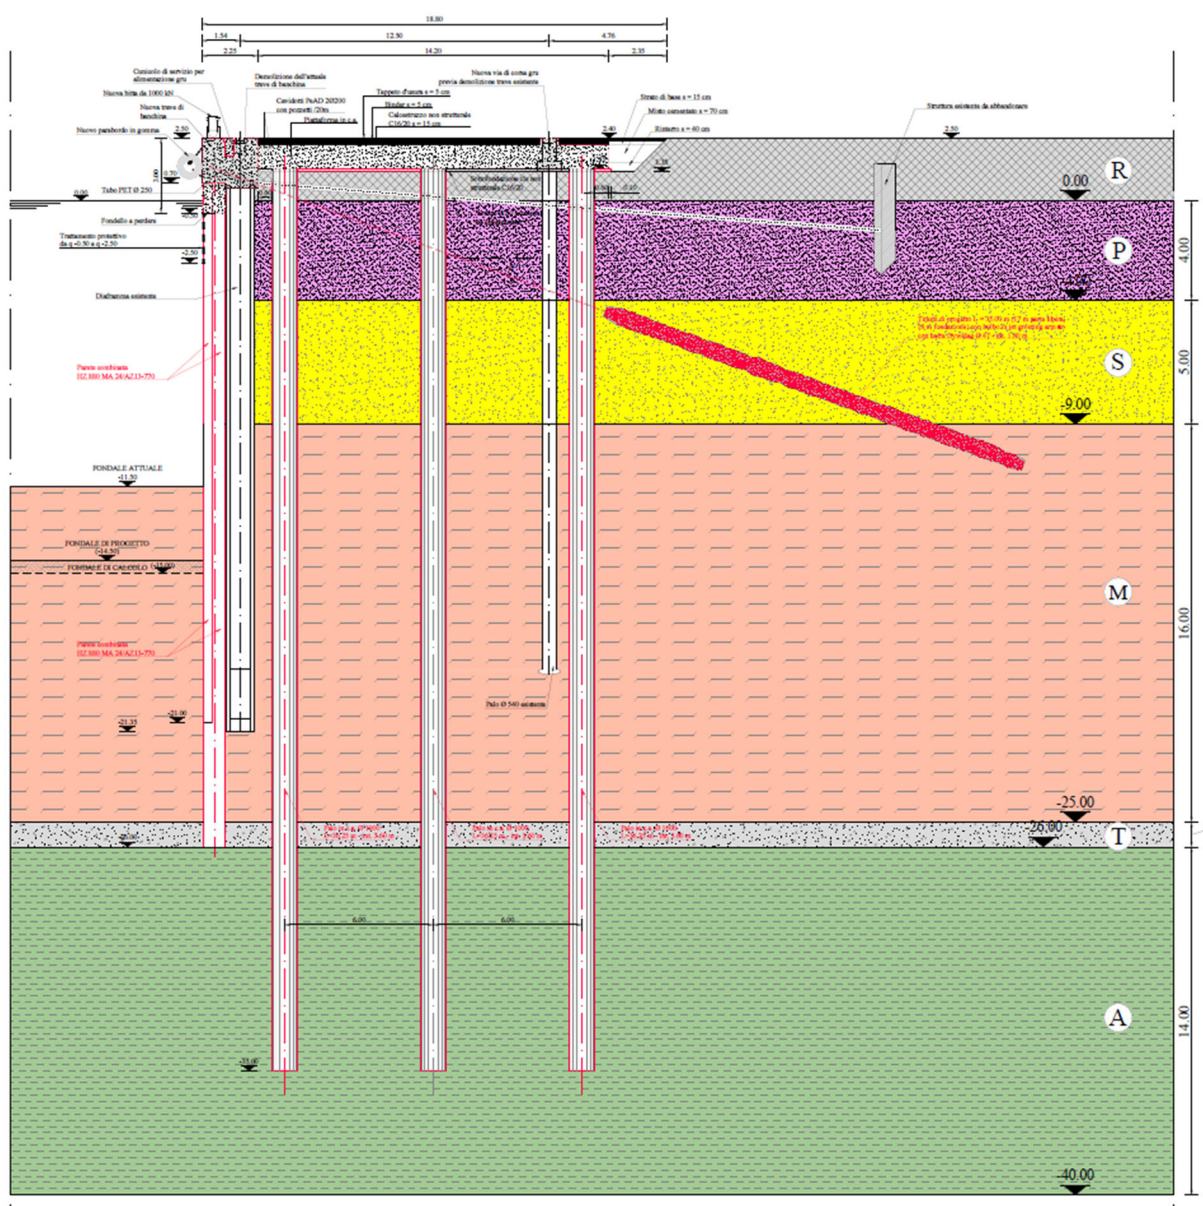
Banchina IFA: Sezione tipo progetto definitivo
